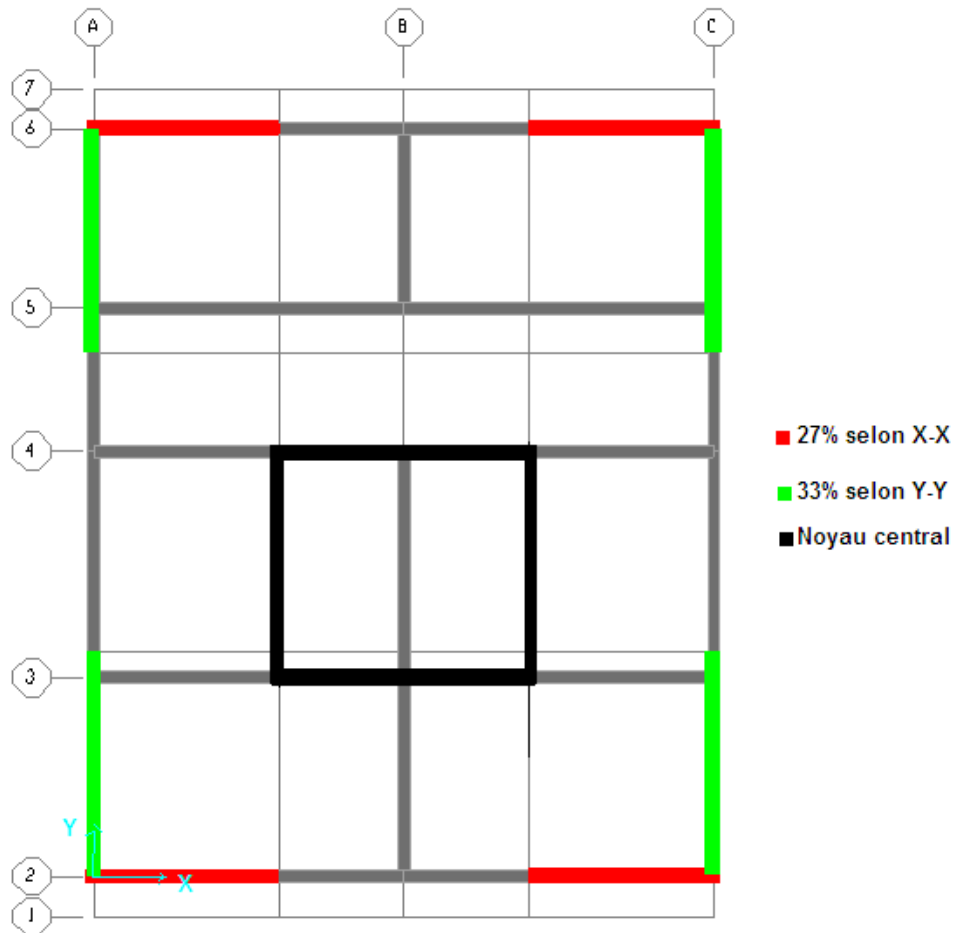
Plan terrasse (axes & pourcentage)
